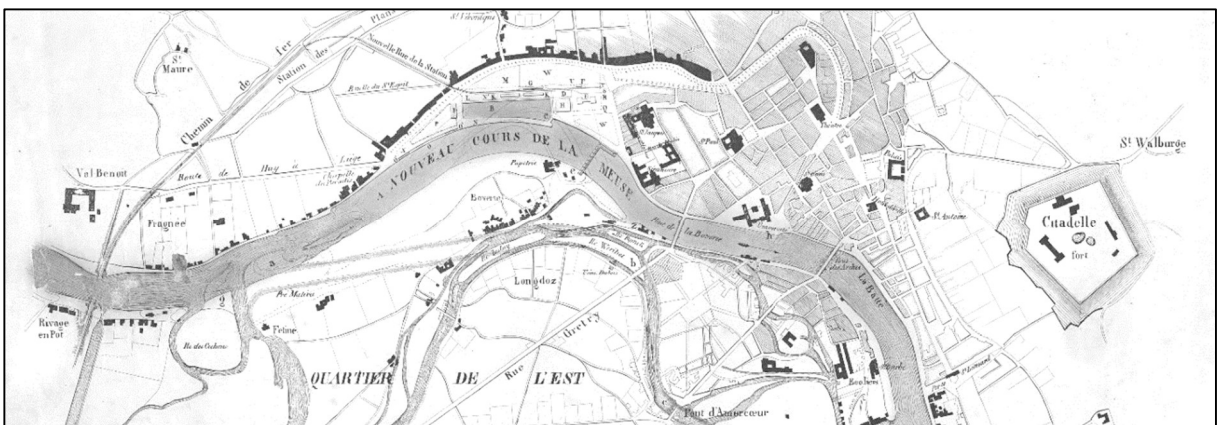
Extrait plan de l'amélioration de la navigation de la Meuse (liège), plan général - 1837
